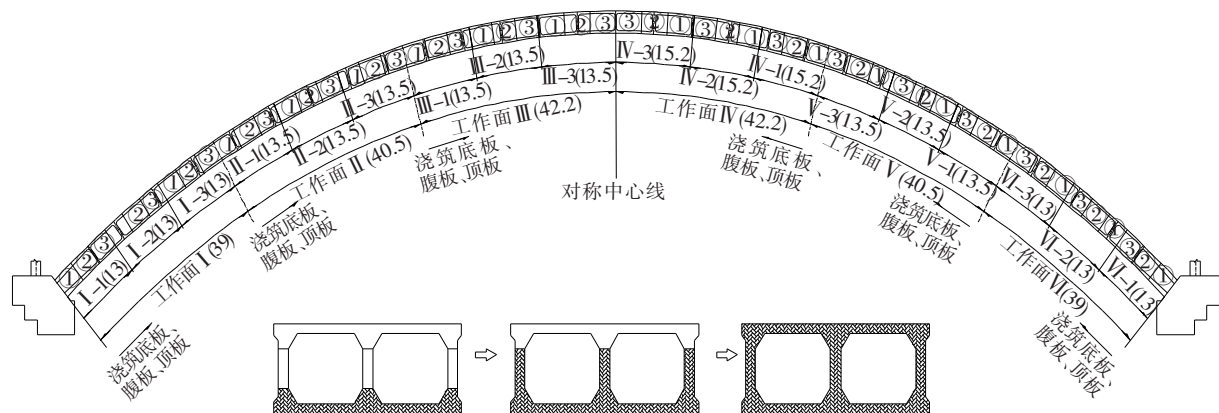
三沙大桥拱圈混凝土浇筑顺序图(单位:m)
